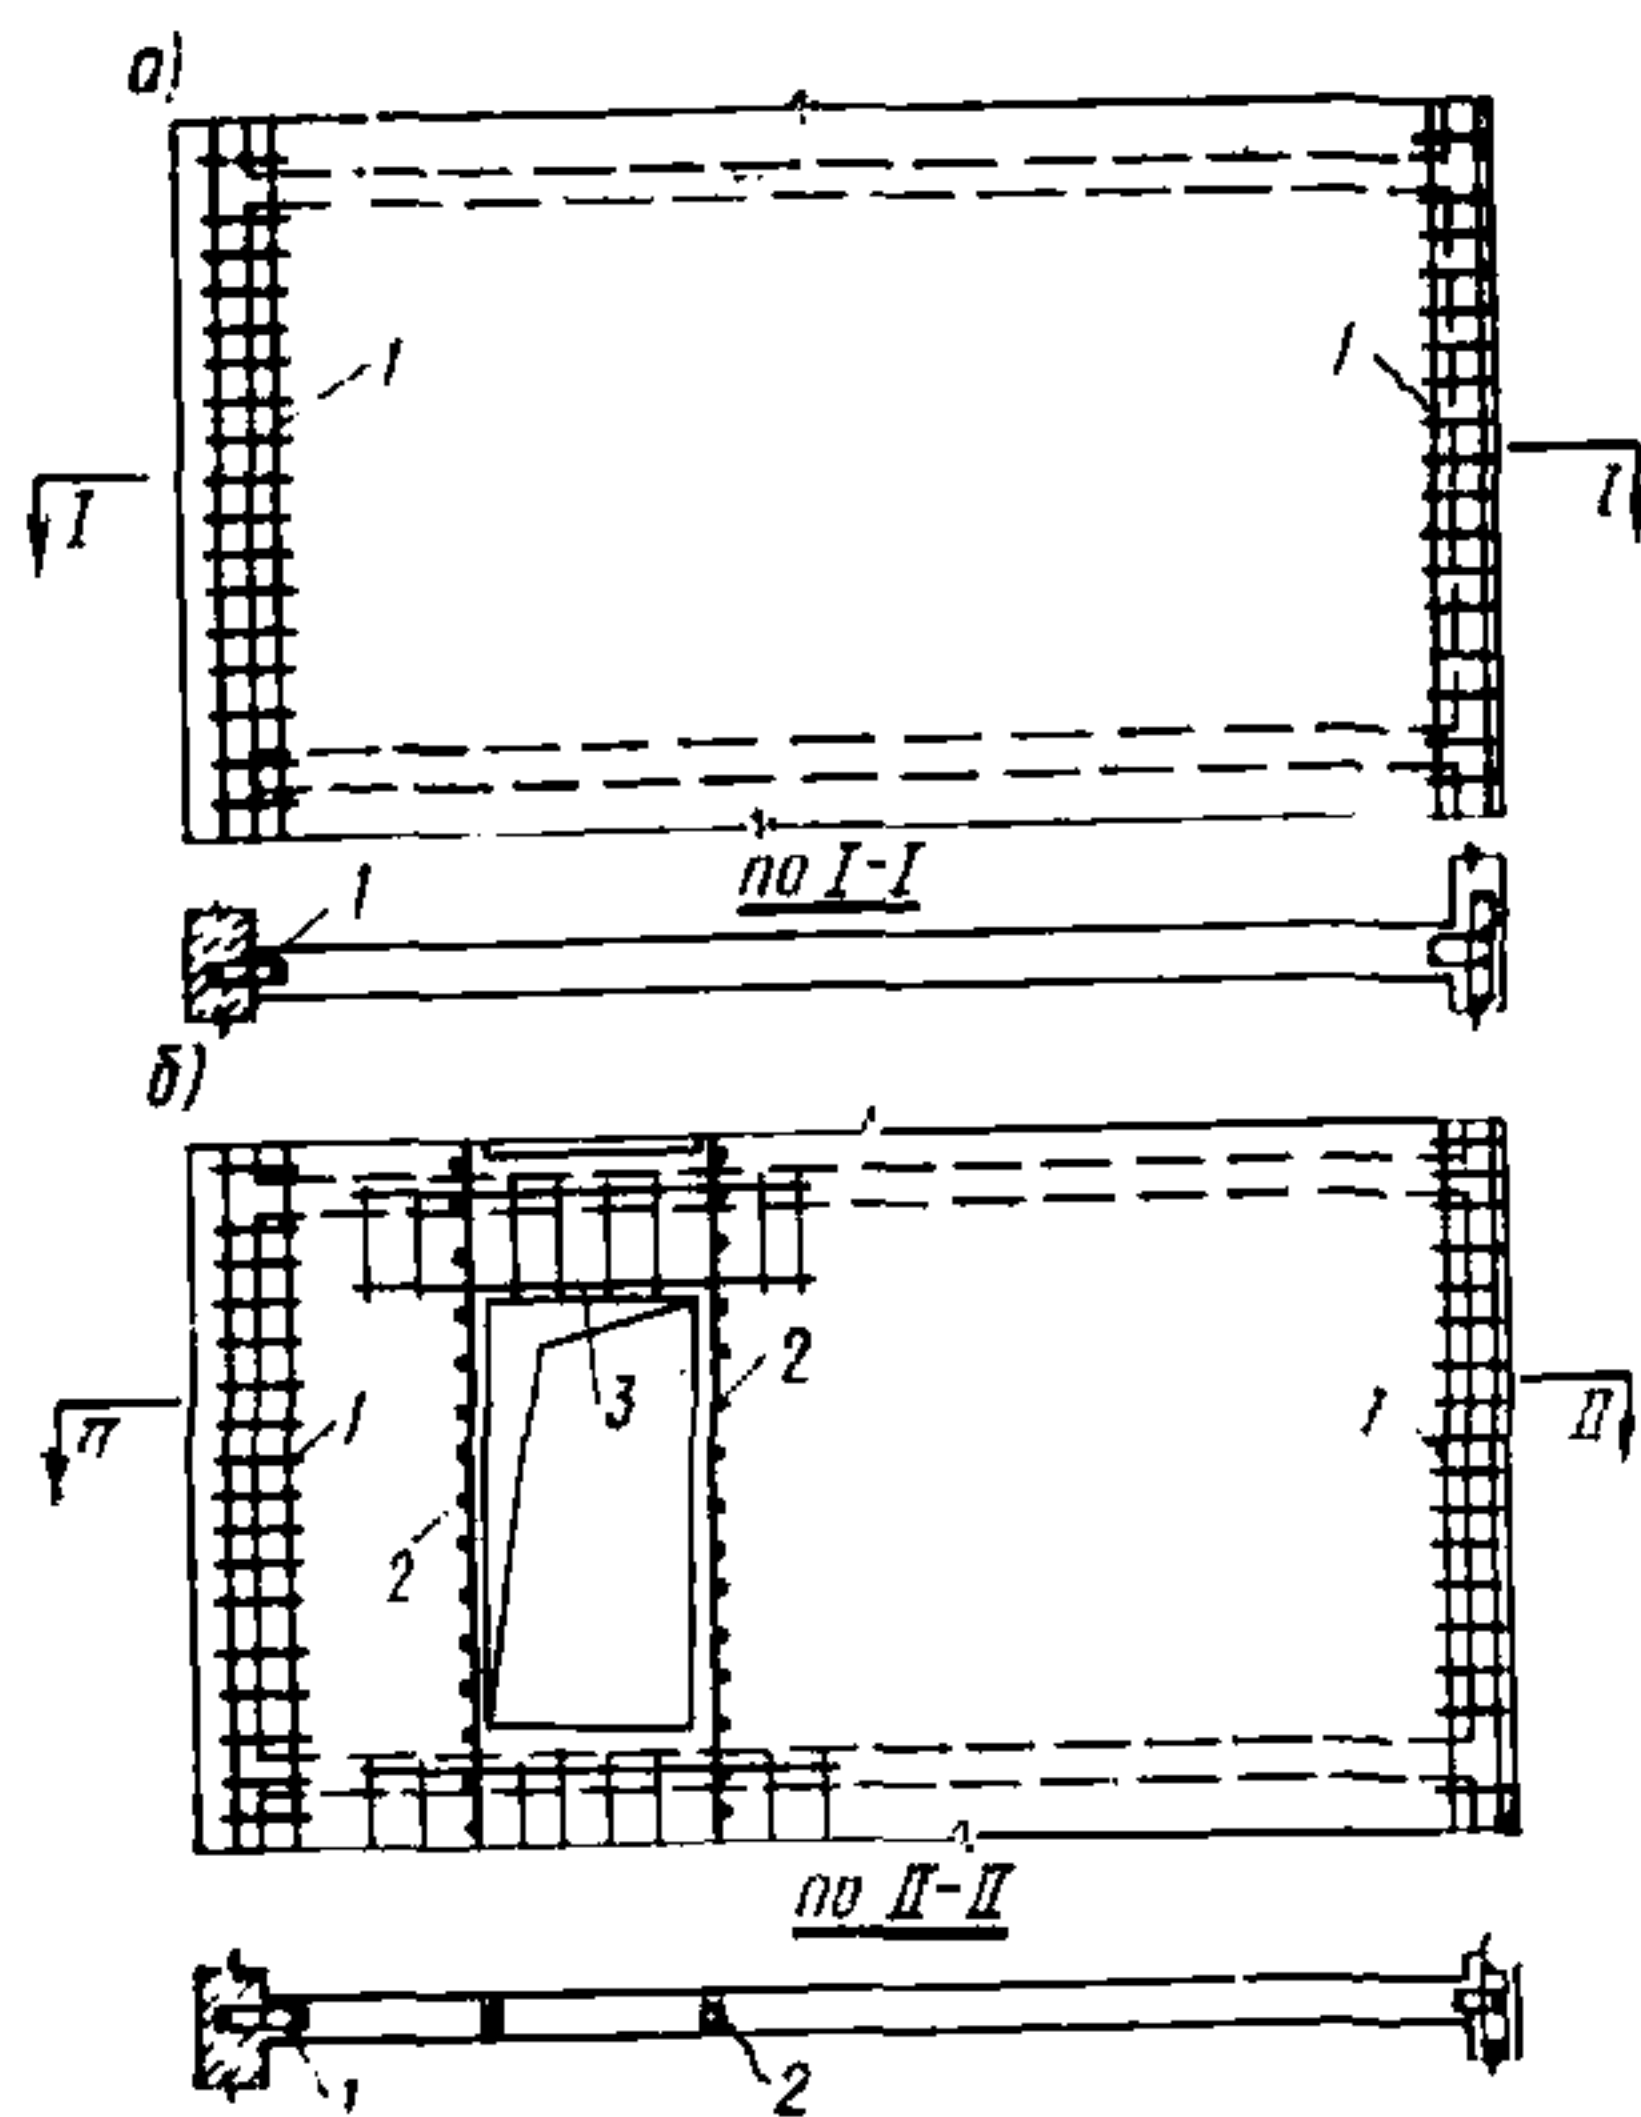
Схема армирования монолитных бетонных внутренних стен
